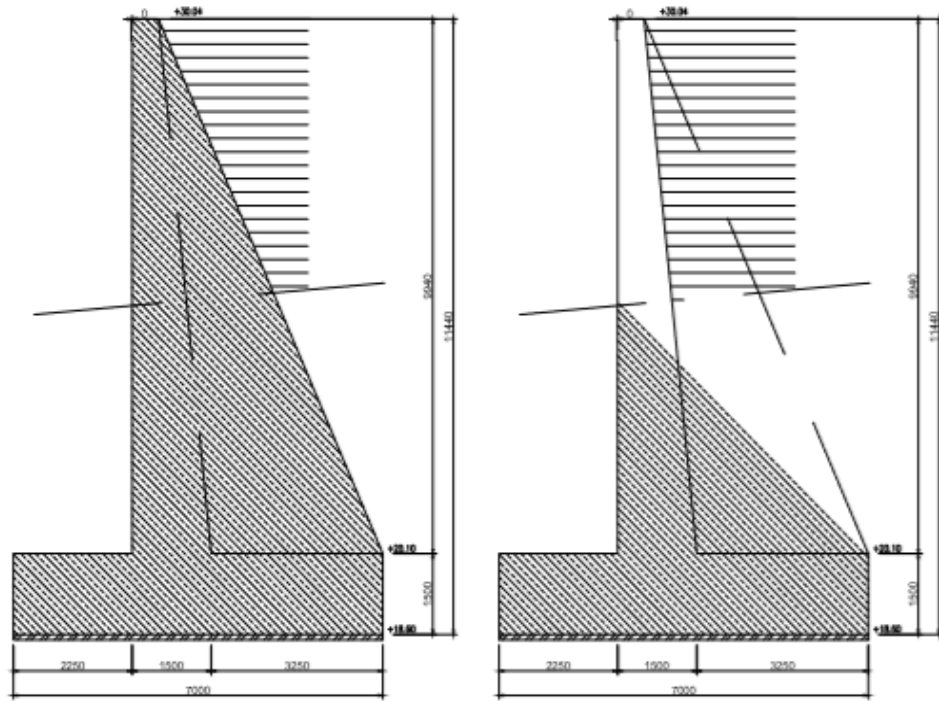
DETAIL PENULANGAN KONSTRUKSI DINDING PENAHAN TANAH TIPE B
